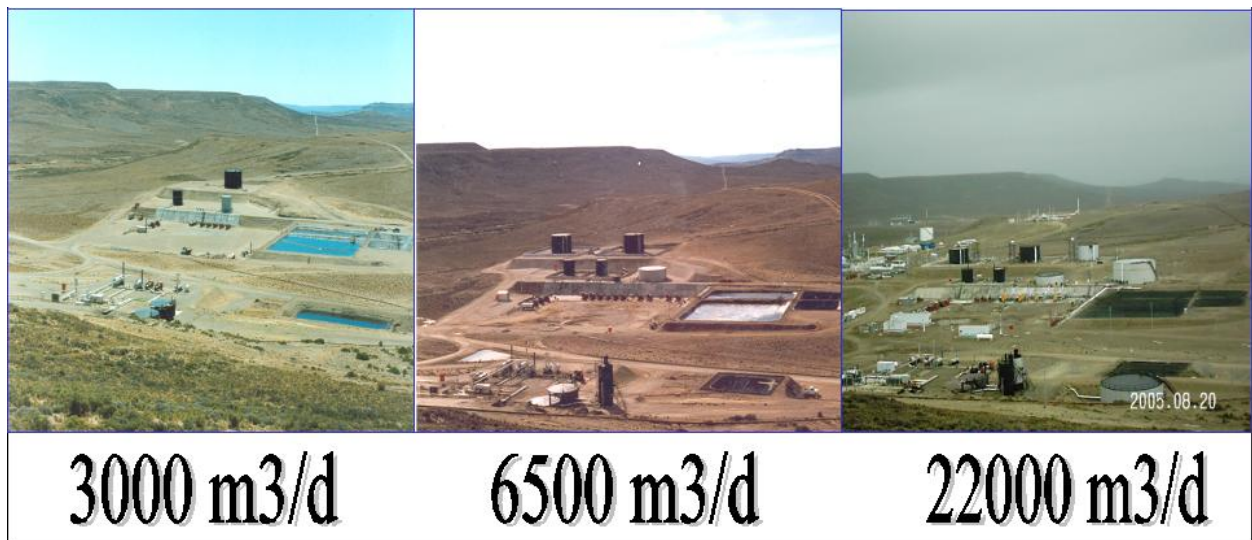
Evolución de la vista panorámica de la planta Zorro 2
